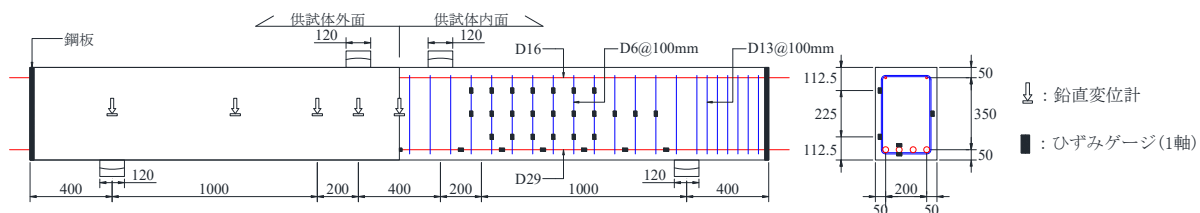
供試体諸元と変位およびひずみの計測位置 (単位: mm)
